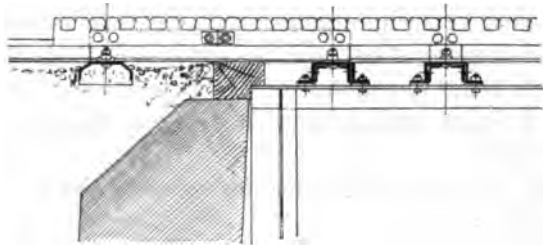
Doppelstühle für die Zahnstange auf eisernen Brücken.
